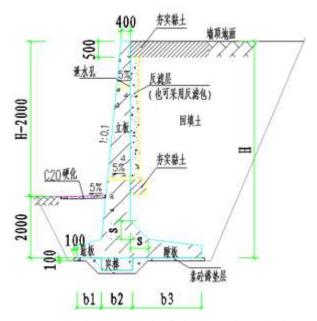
挡墙断面图 (悬臂式钢筋混凝土挡墙)
